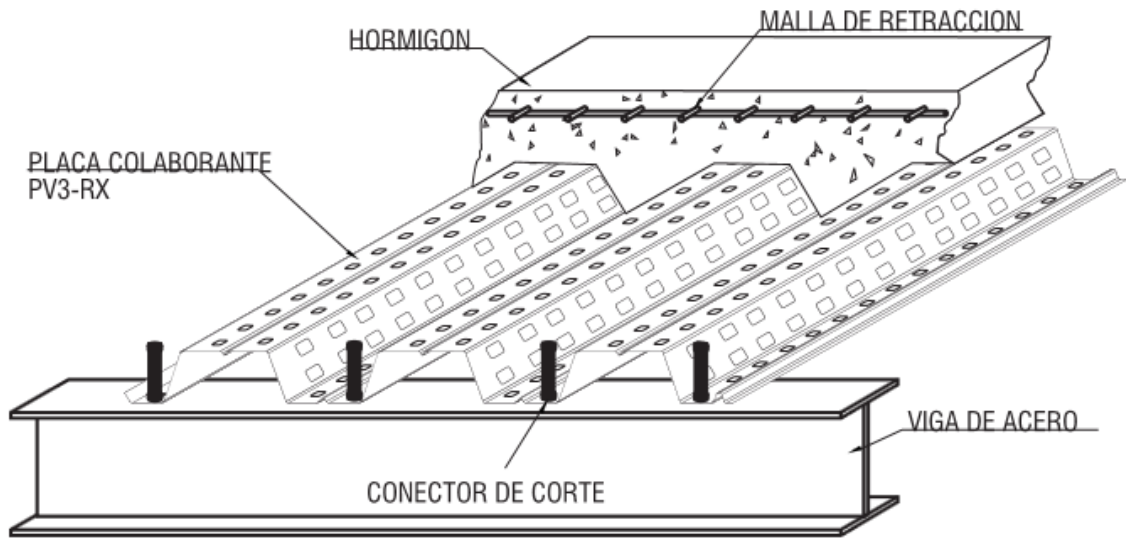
Esquema del Deck. Fuente: Diseño acero estructural. Elaborado por: Marco Benalcázar.
